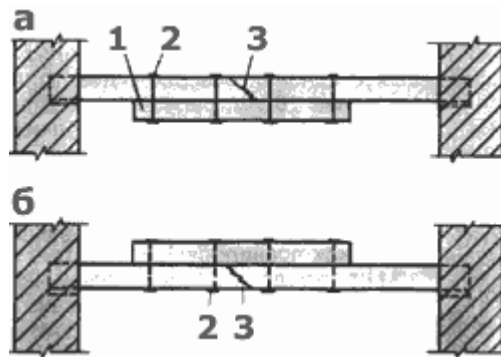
Установка накладок на поврежденную балку снизу (а) и сверху (б): 1 - накладка; 2 - болты; 3 - надломленная балка.
